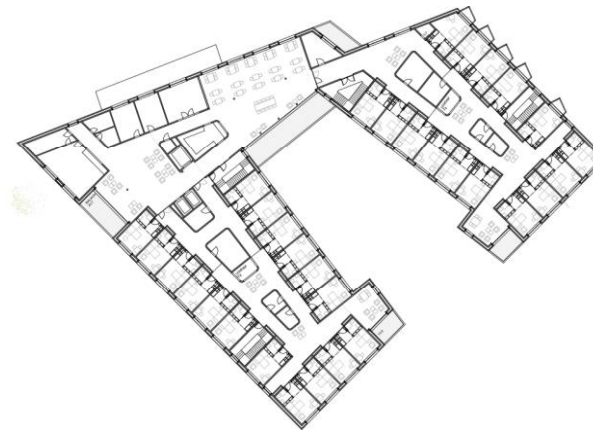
Pflegeheim Bifang: Grundriss Zimmergeschoss
